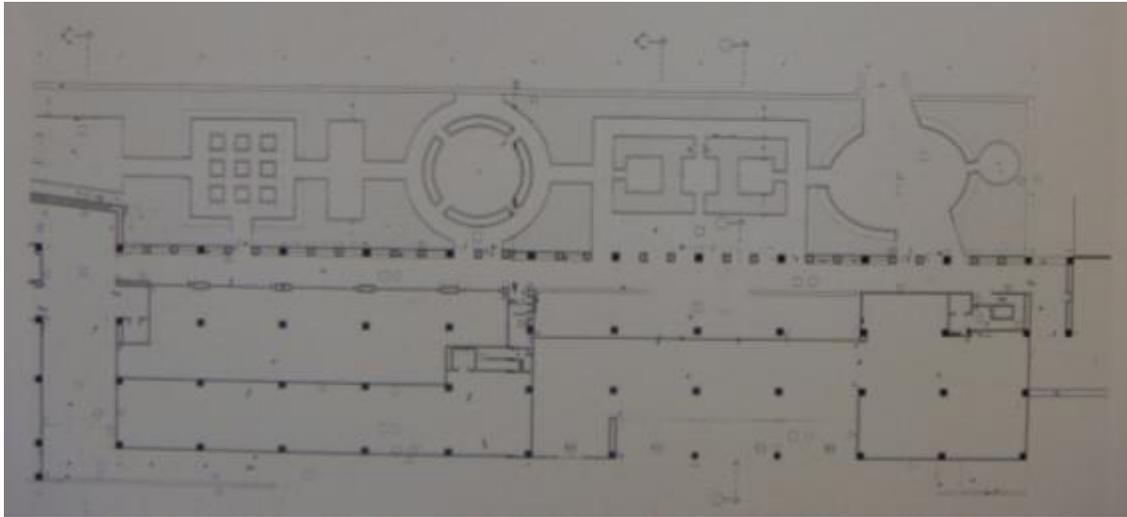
Edificio Central. Fuente: Archivo AINDABIIN.
